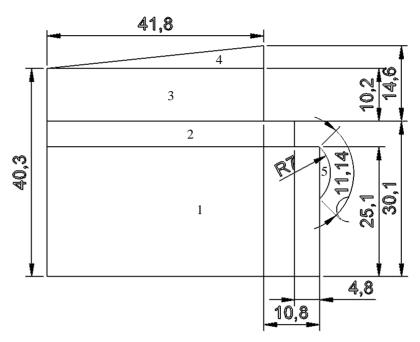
Plano de la planta con medidas interiores. Nota: Escala: 1:733.
